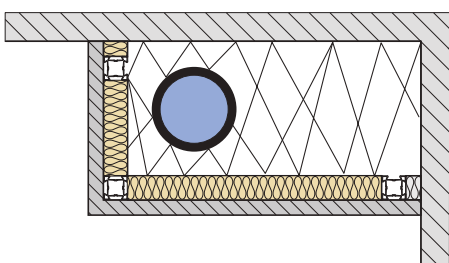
Riflesso sonoro ridotto in un sistema di installazione con isolamento fonoassorbente
